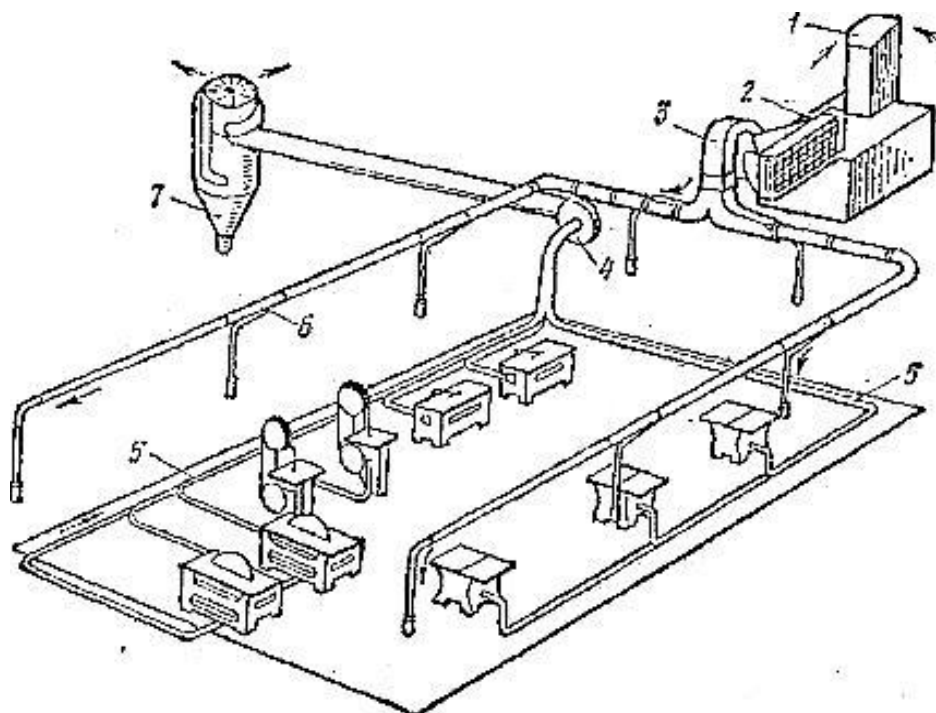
Схема механической вентиляции: 1 – воздухозаборная шахта; 2 – калорифер; 3 – подача воздуха; 4 – вытяжной вентилятор; 5 – воздуховоды вытяжной вентиляционной установки; 6 – вентканалы; 7 – циклон
